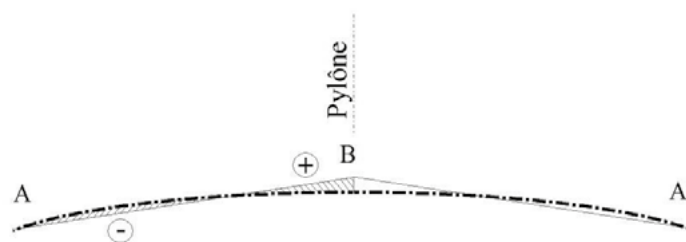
vue en plan (pour faciliter la compréhension, seul le hauban moyen est représenté)
